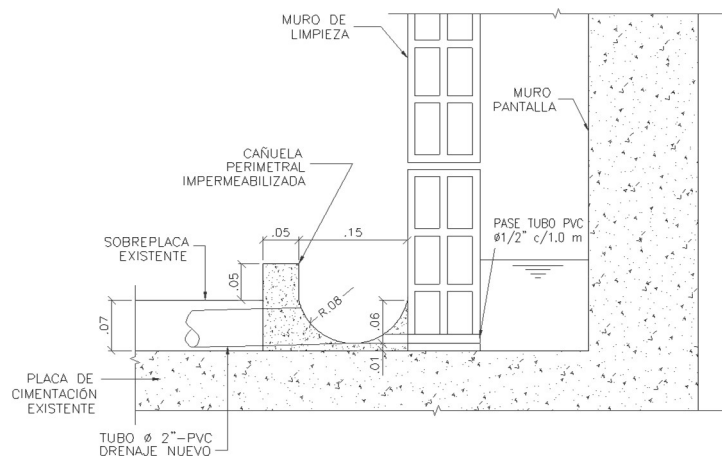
Detalle de obras de drenaje de la solución propuesta (archivo propio)
